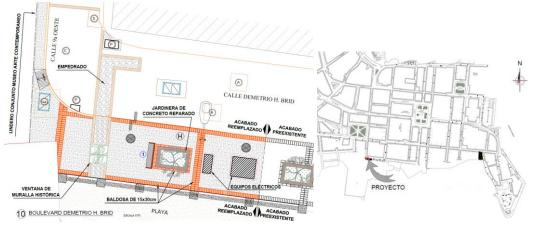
Detalle de intervención para Plaza de Av. Demetrio Brid. Fuente: Proyecto Paisajismo de plazas del Casco Antiguo, MUPA, 2013
